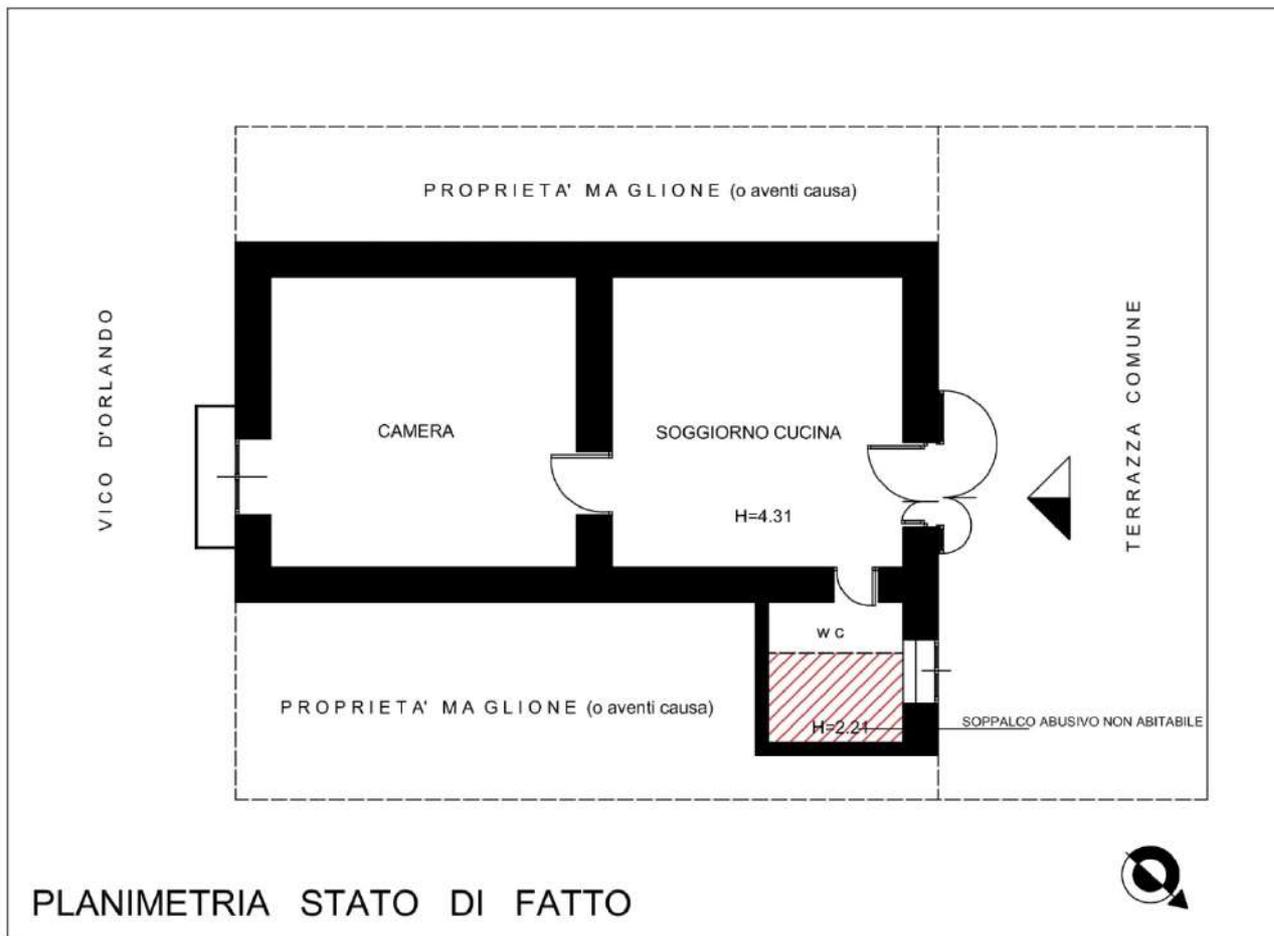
Pianta dello stato di fatto con individuazione delle opere abusive
